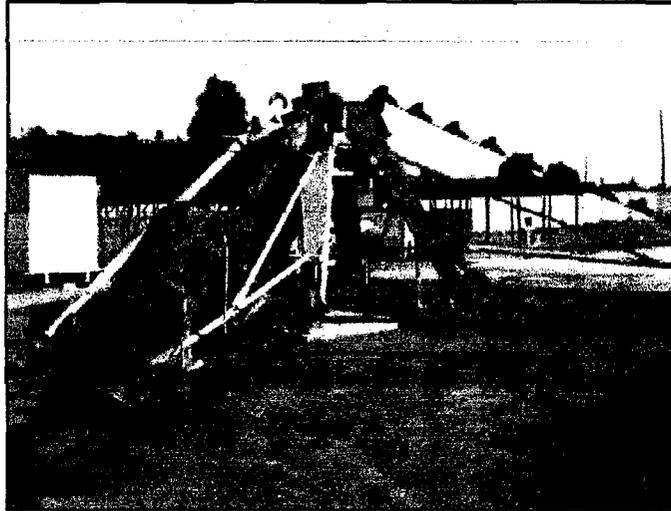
Planta a brazos raspantes PICCINI MF400 instalada en obra.
